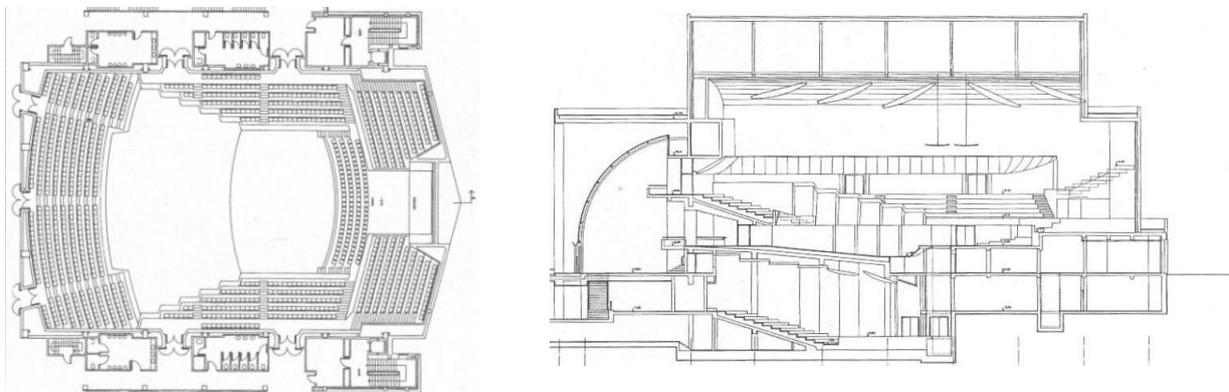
Palau de la Música: planta (cota 8,33) y sección longitudinal
